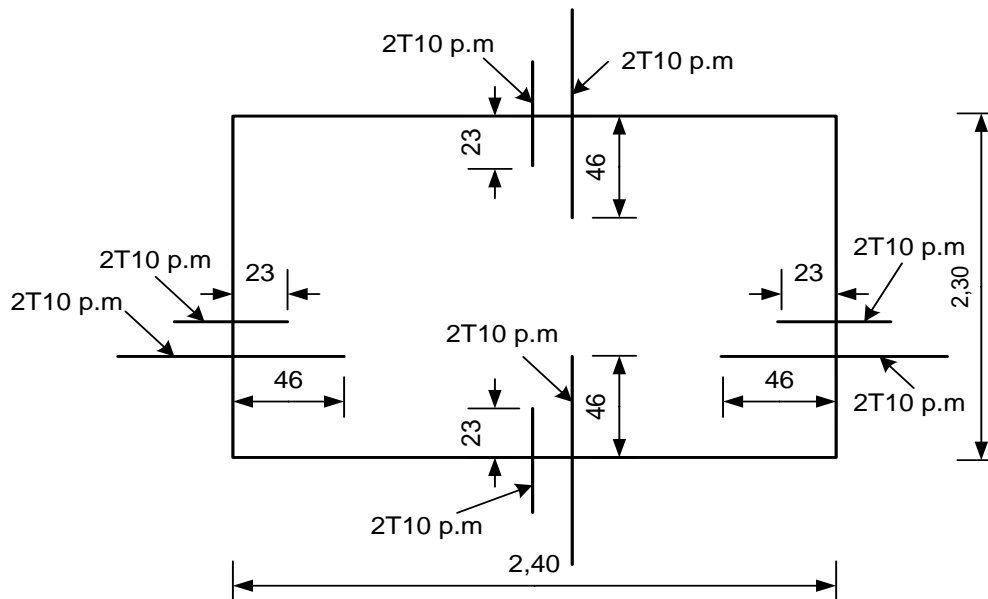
Ferrailage Supérieur (sur appui) du panneau de dalle d'ascenseur
